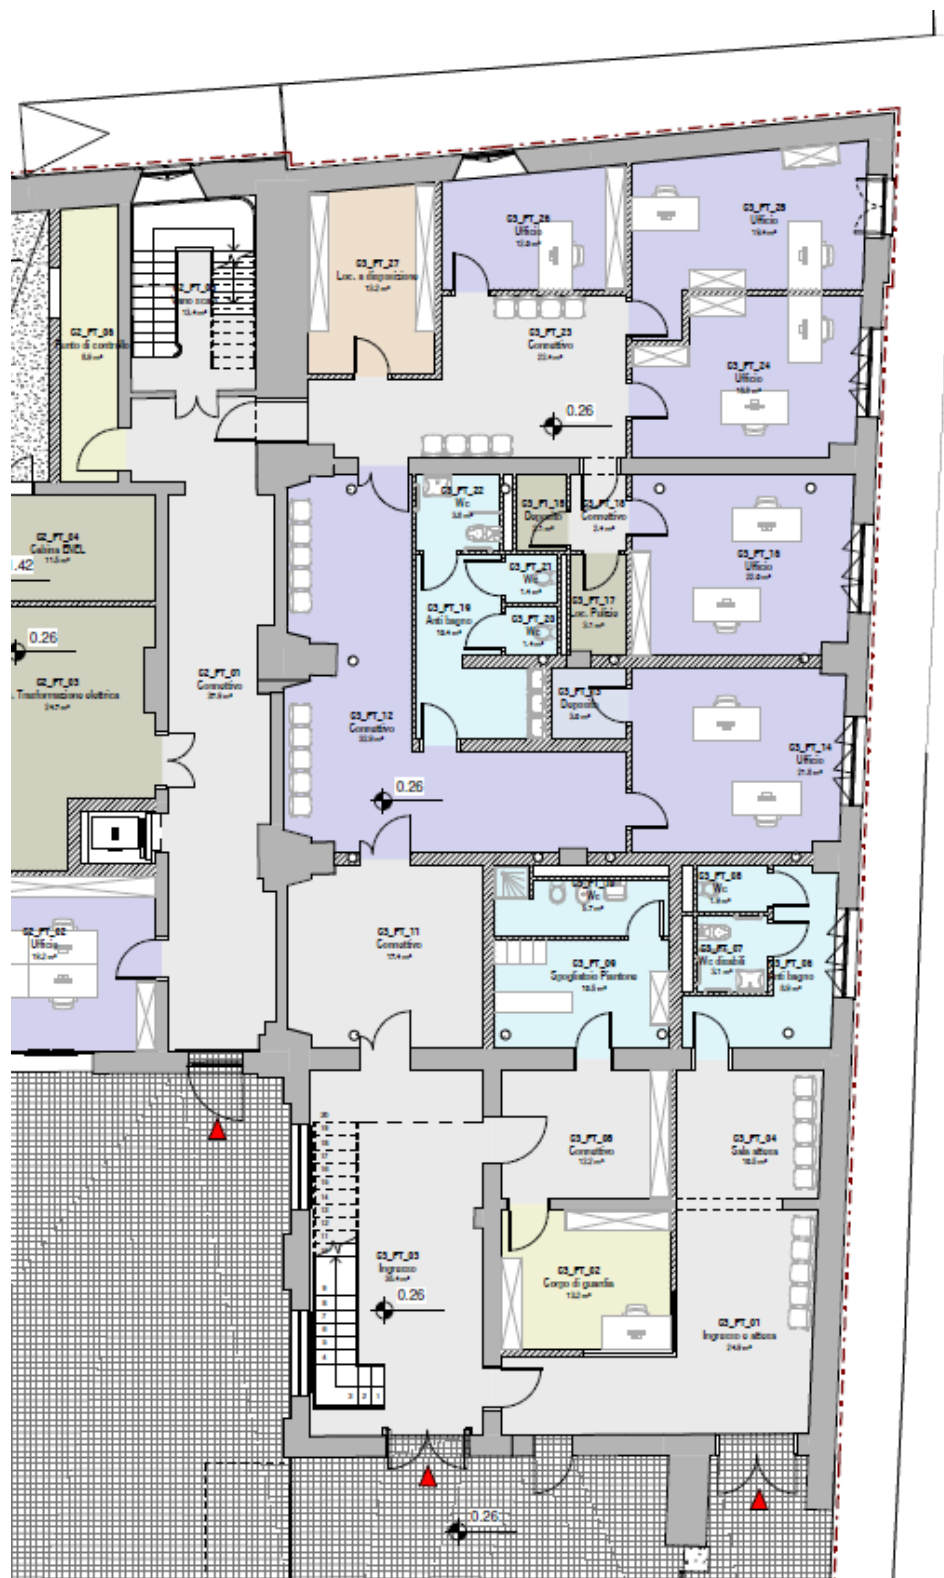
Edificio C3, pianta piano terra – estratto della pianta con le indicazioni funzionali
